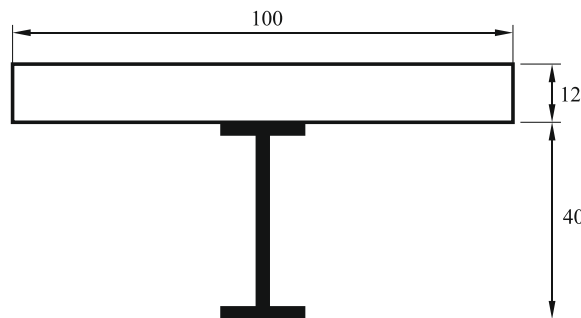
Сечение сталежелезобетонной балки с необетонированным стальным двутавром
